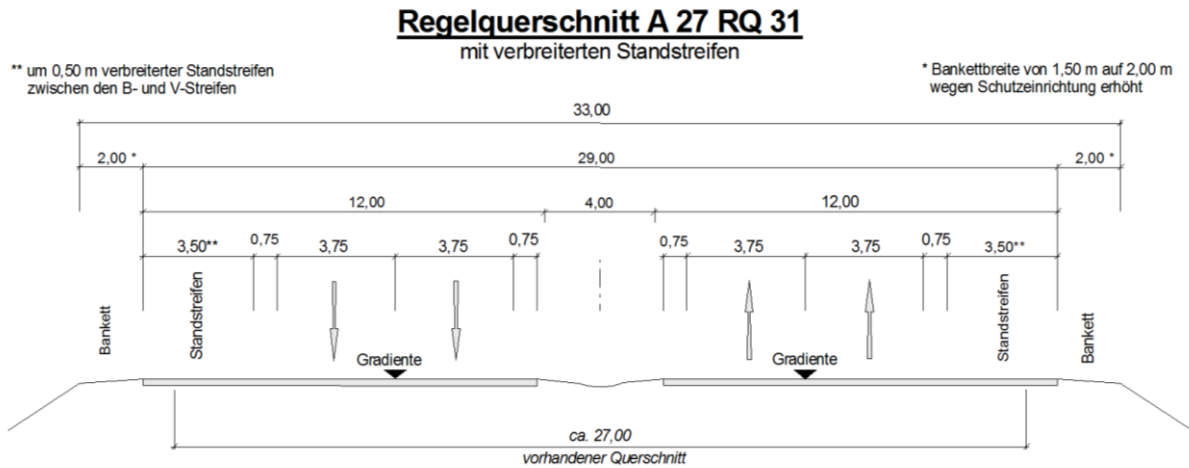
Regelquerschnitt A 27 RQ 31.
